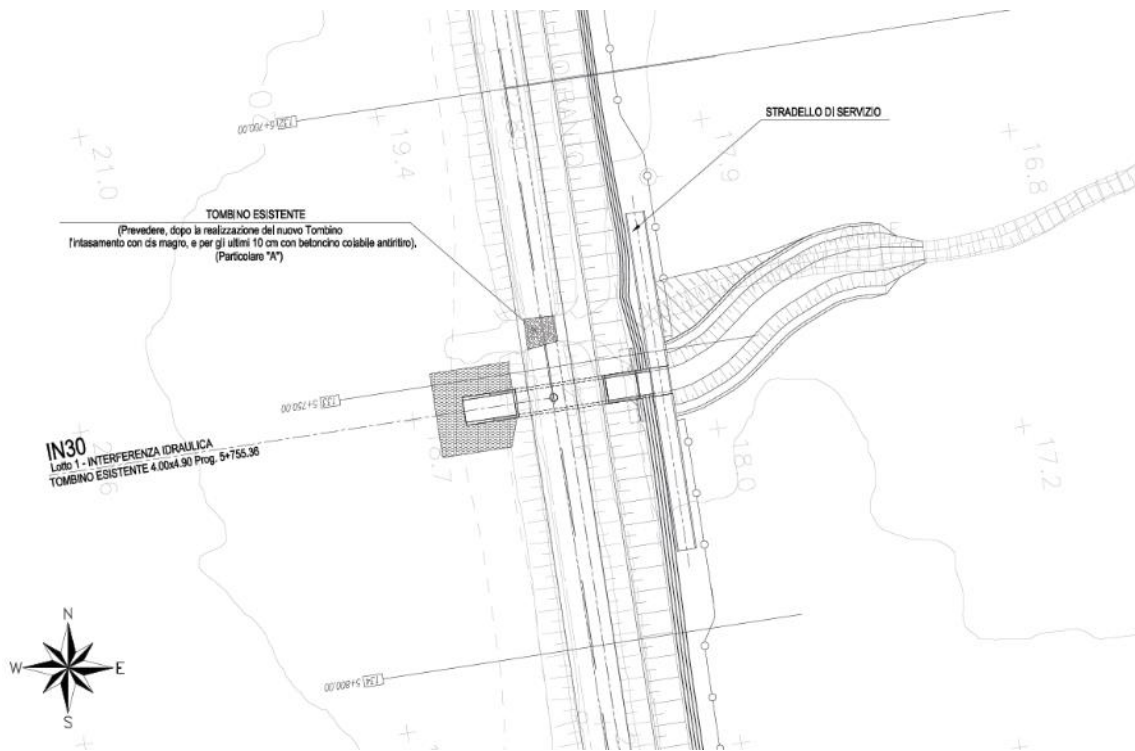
Adeguamento idraulico Fosso Capoposta – Vista Planimetrica
